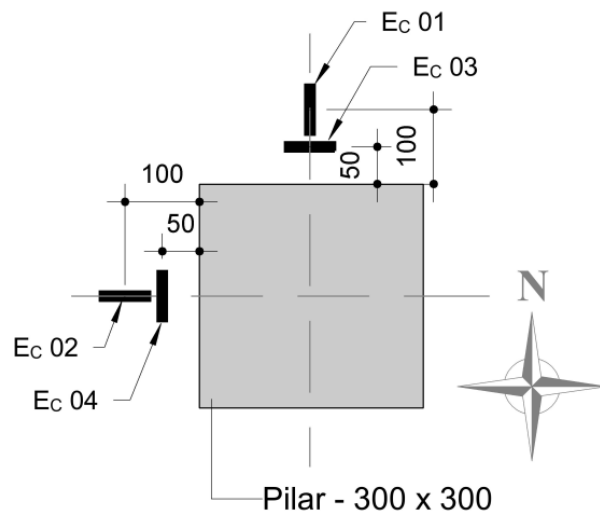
Instrumentação do concreto na parte inferior da laje (unidades em milímetros)
